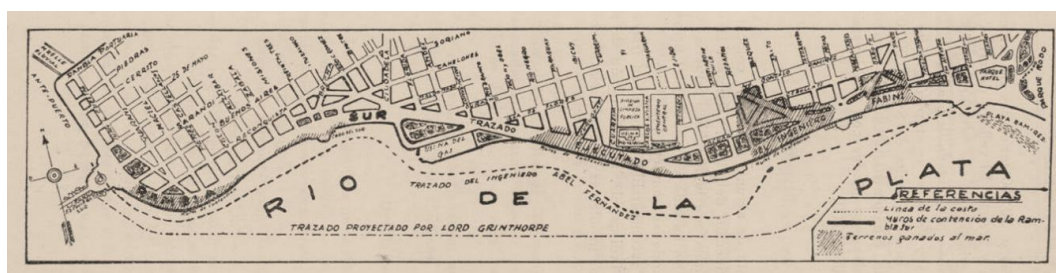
Plano de obras de la Rambla Sur. Trazado de Juan Pedro Fabini (1922).
